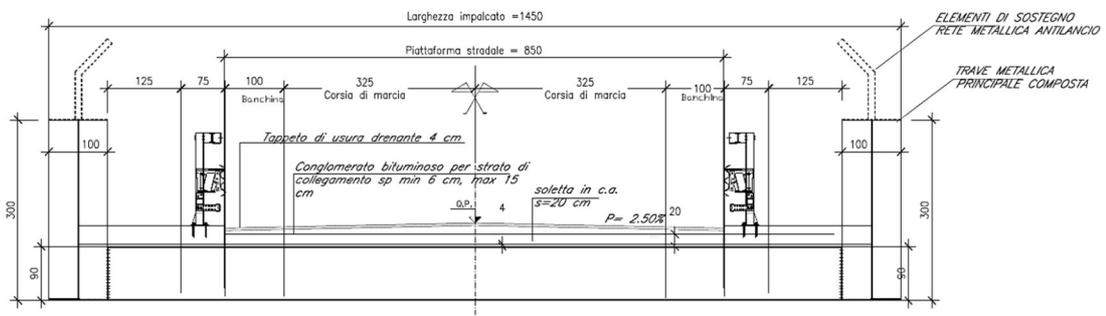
Sezione tipo impalcato del viadotto stradale NW01
